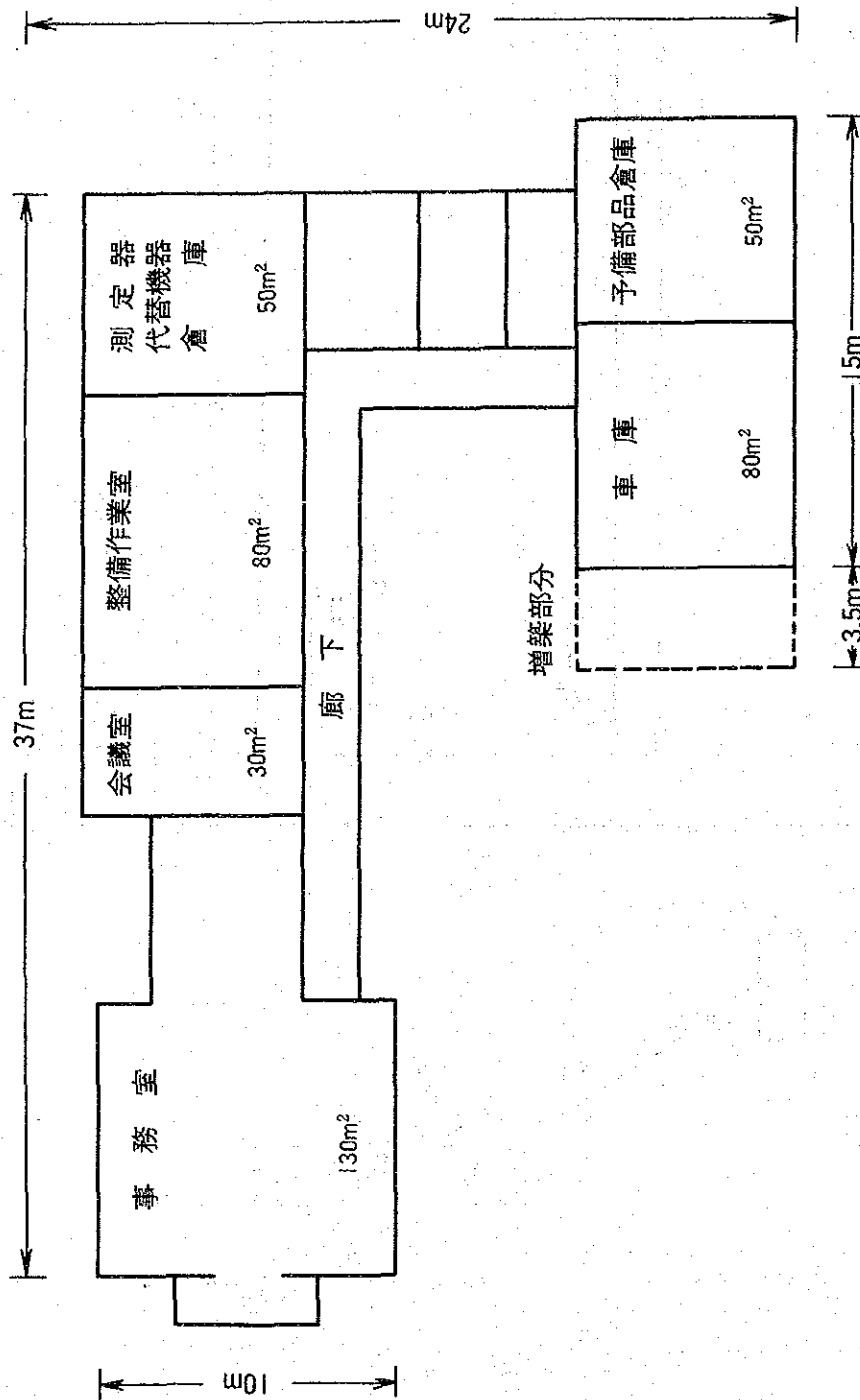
ウジュンパンダン地方技術センター平面図 1/250
